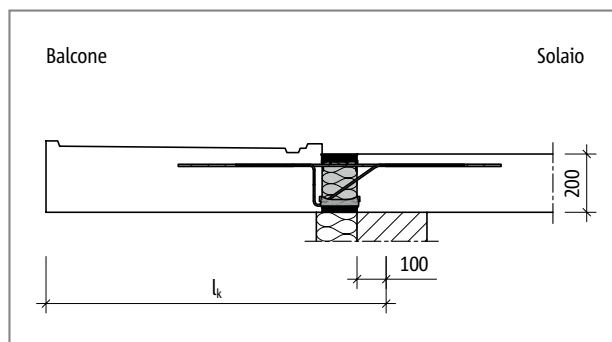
Schöck Isokorb® XT tipo KL: schema statico
